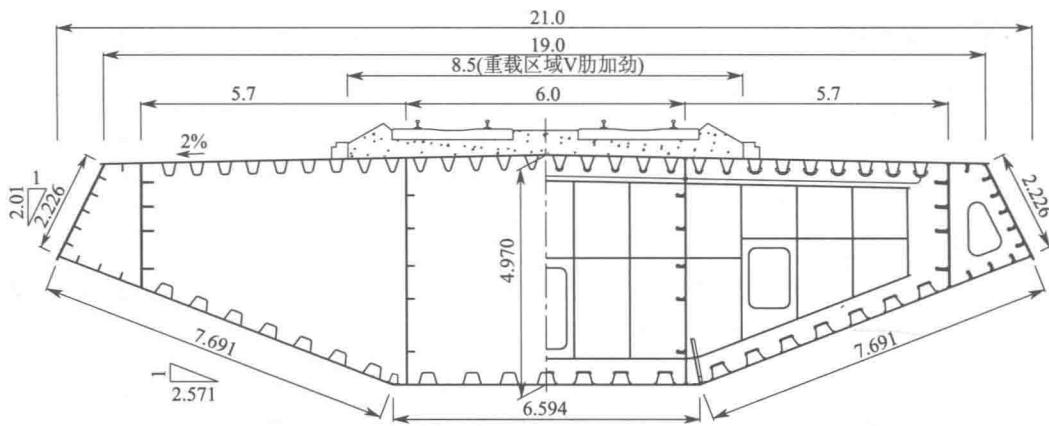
钢箱加劲梁截面图(单位:m)
